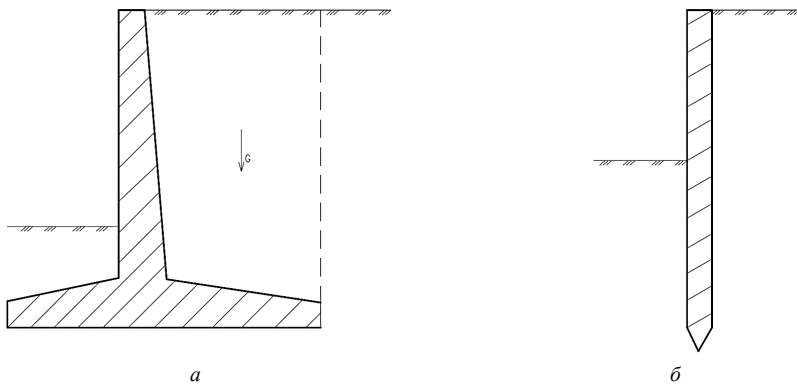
Тонкие (а) и шпунтовые (б) подпорные стены
